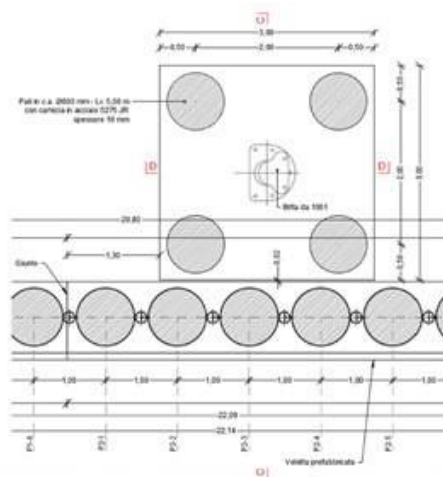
Paratia Tipo 1 e Tipo 2: planimetria
